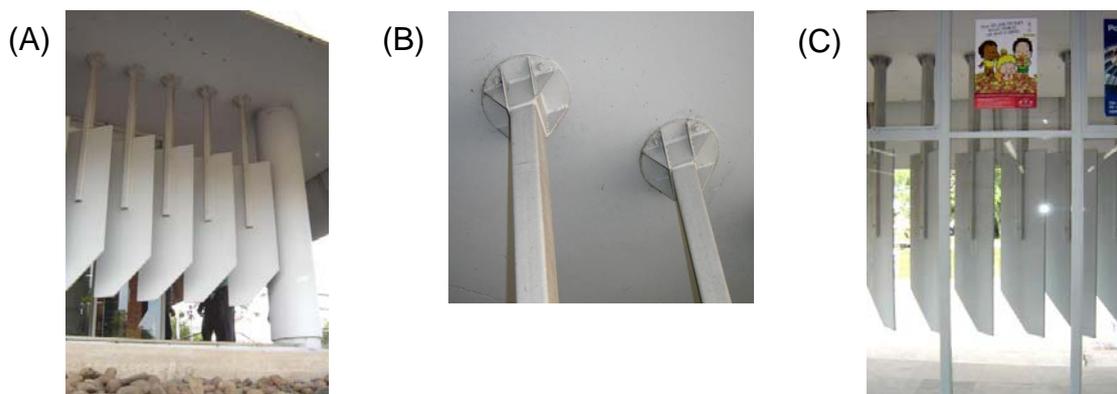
(A) vista dos *brises* verticais (B) detalhe da fixação dos perfis metálicos na laje (C) vista interna do Banco
